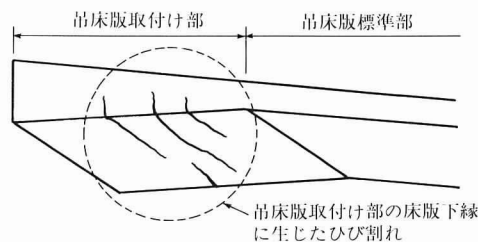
吊床版取付け部に生じるひび割れ状況
